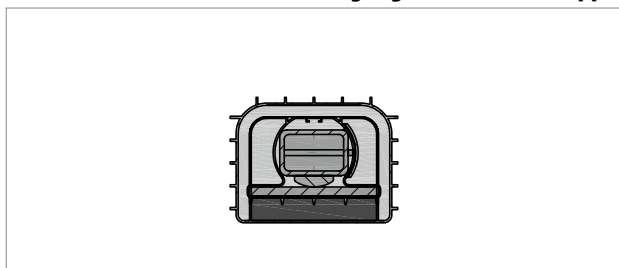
Tronsole® Q: Einbauvariante waagrecht Einbau des Tragelements
